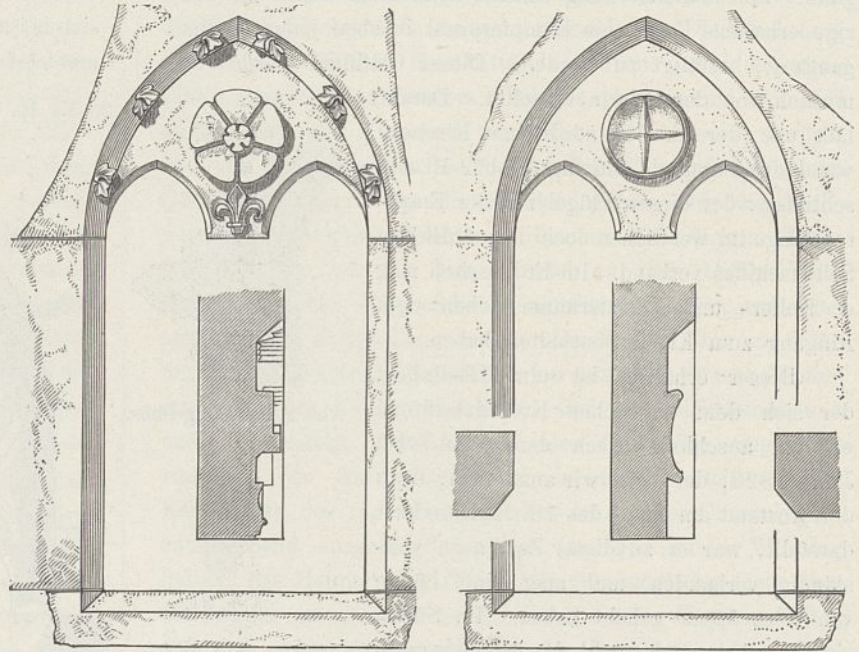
Fenster im Dachgeschoß. Abb. 32.
